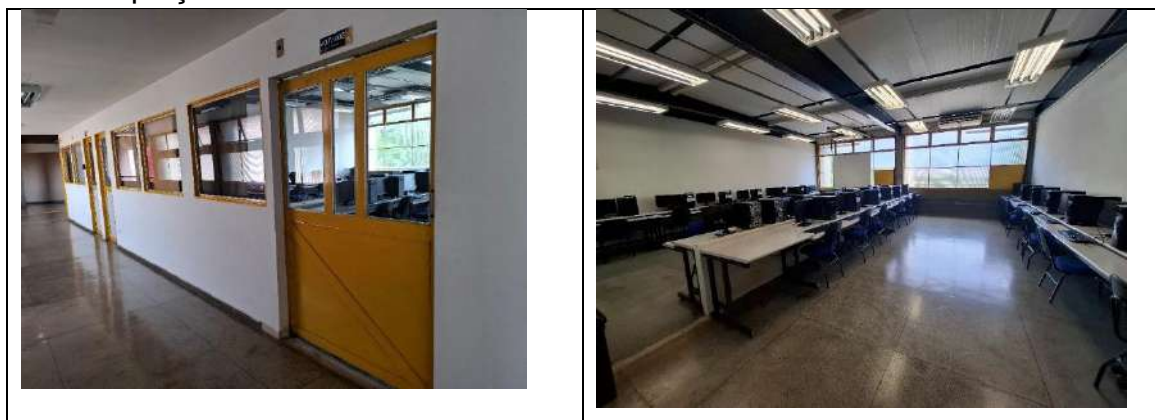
adequação salas de aula - Bloco E - Área 4 para recebimento de refrigeração nos espaços acadêmicos
